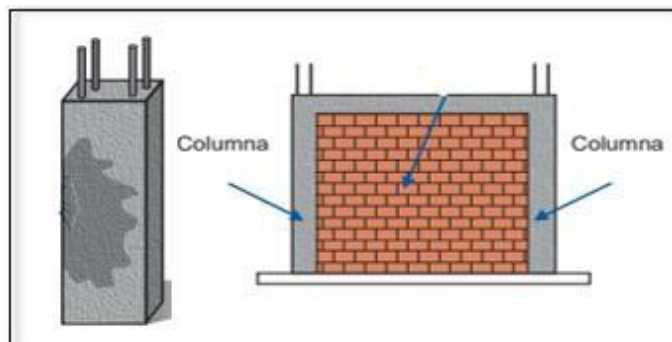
Columna. – Fuente: Medina R, Blanco A.³³
